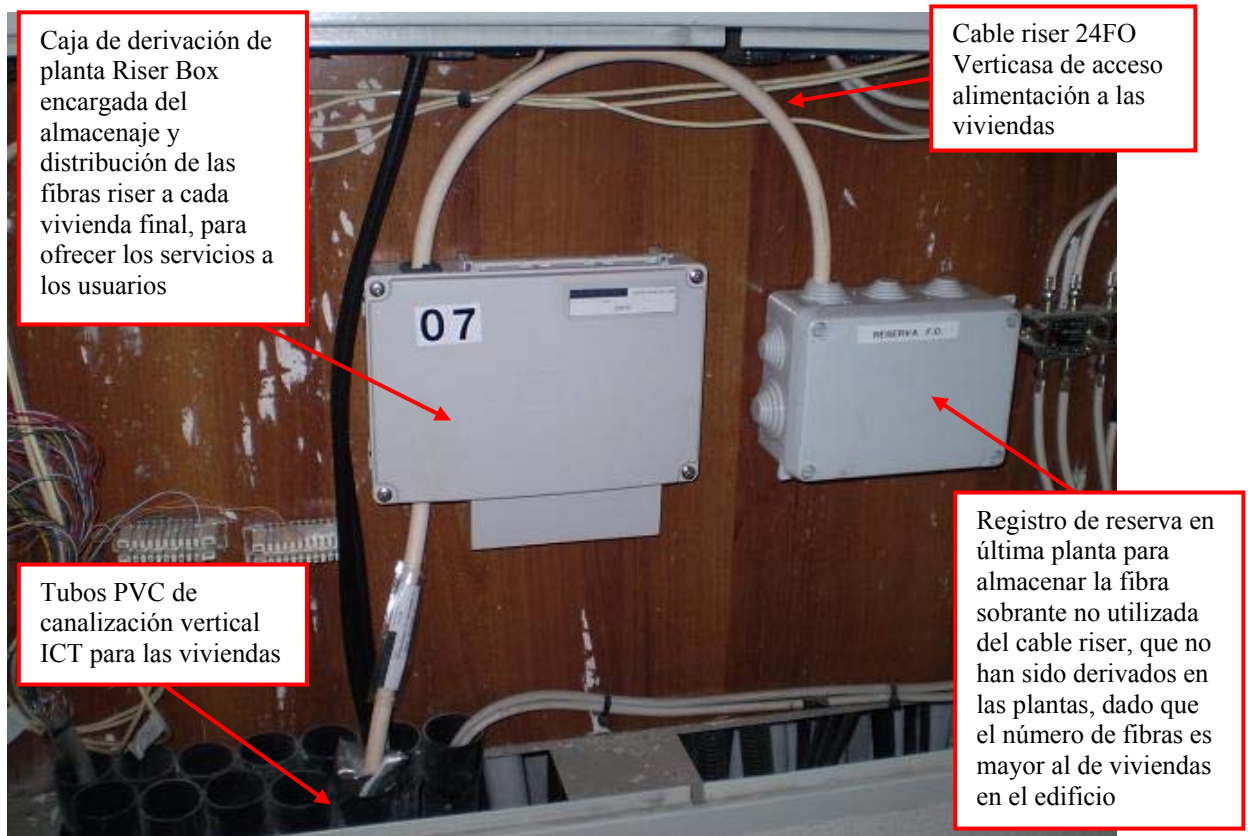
Vista interior del acceso al patinillo de canalización ICT vertical de las viviendas (planta ático)
